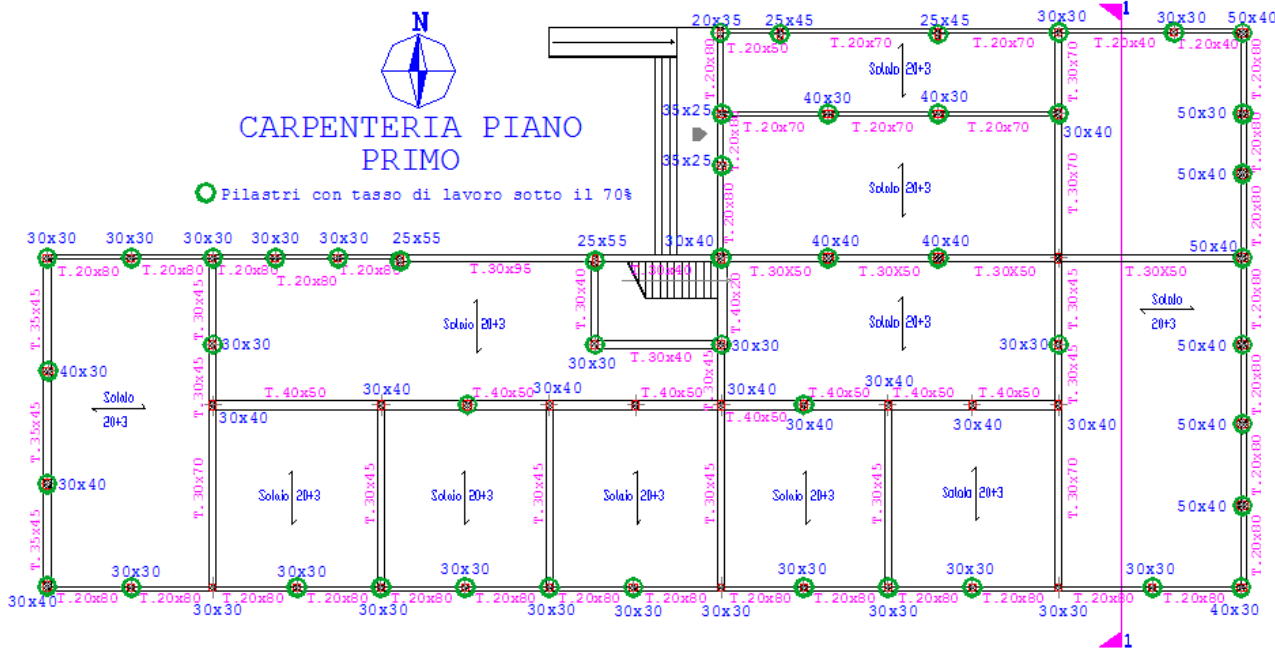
Pilastri al piano primo con tasso di lavoro inferiore al 70%
